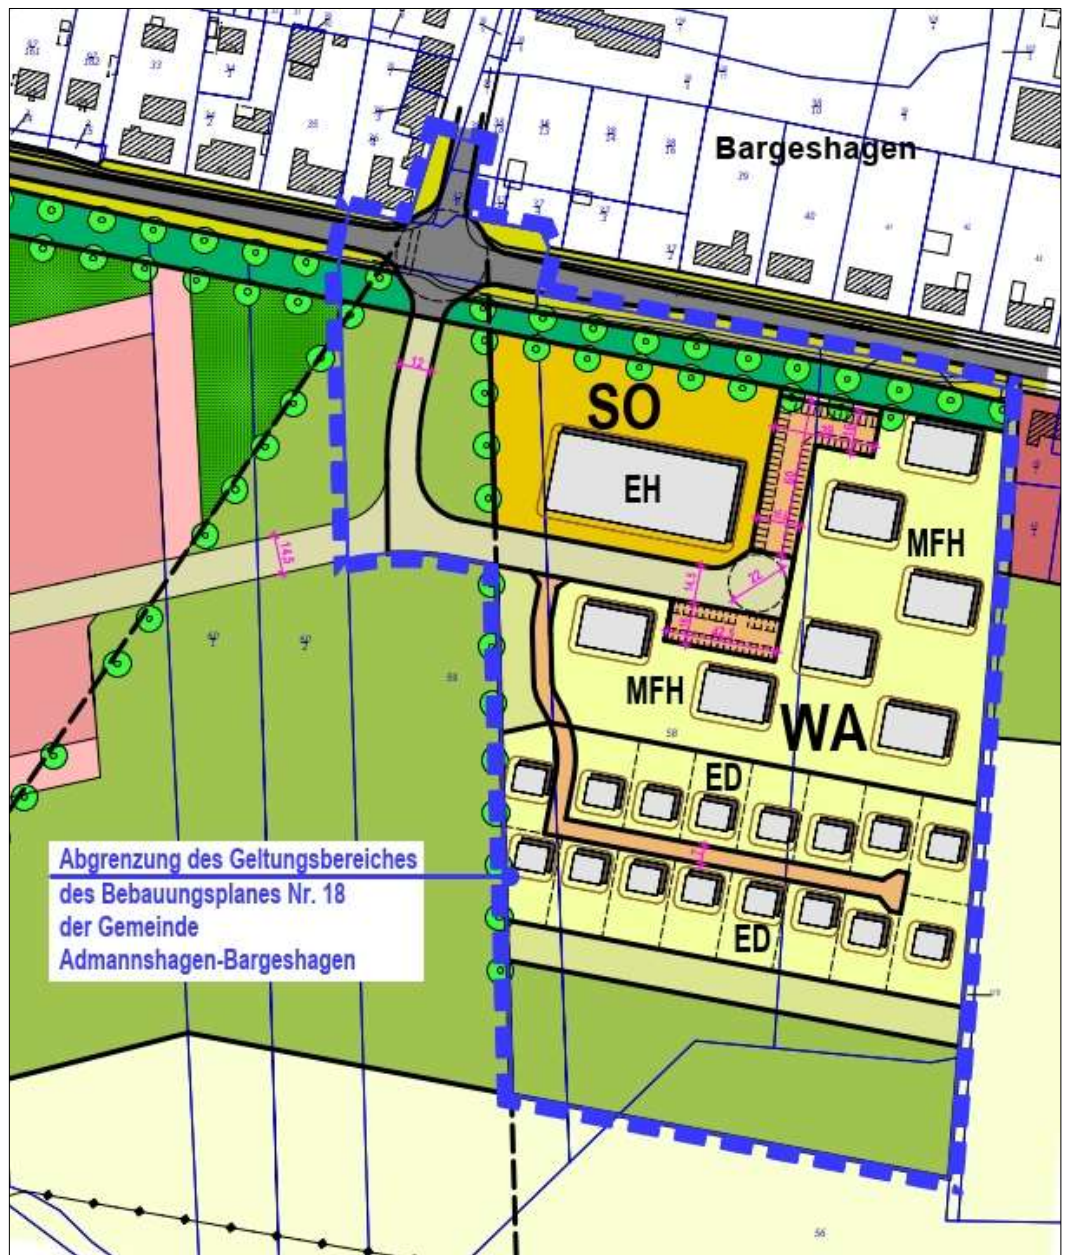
Gebietserweiterung laut B-Plan Nr.18 mit Planstraße als vierter Knotenarm
